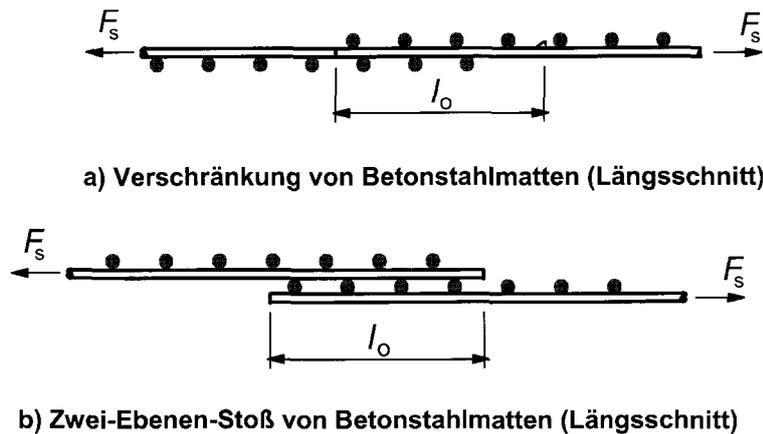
Übergreifungsstöße von geschweißten Betonstahlmatten
